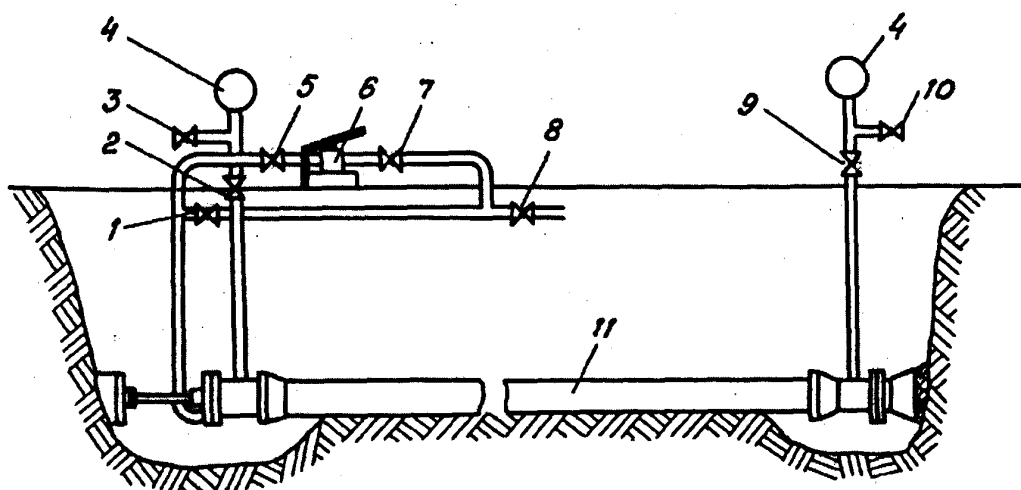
Схема гидравлического испытания участка водопроводной сети:
